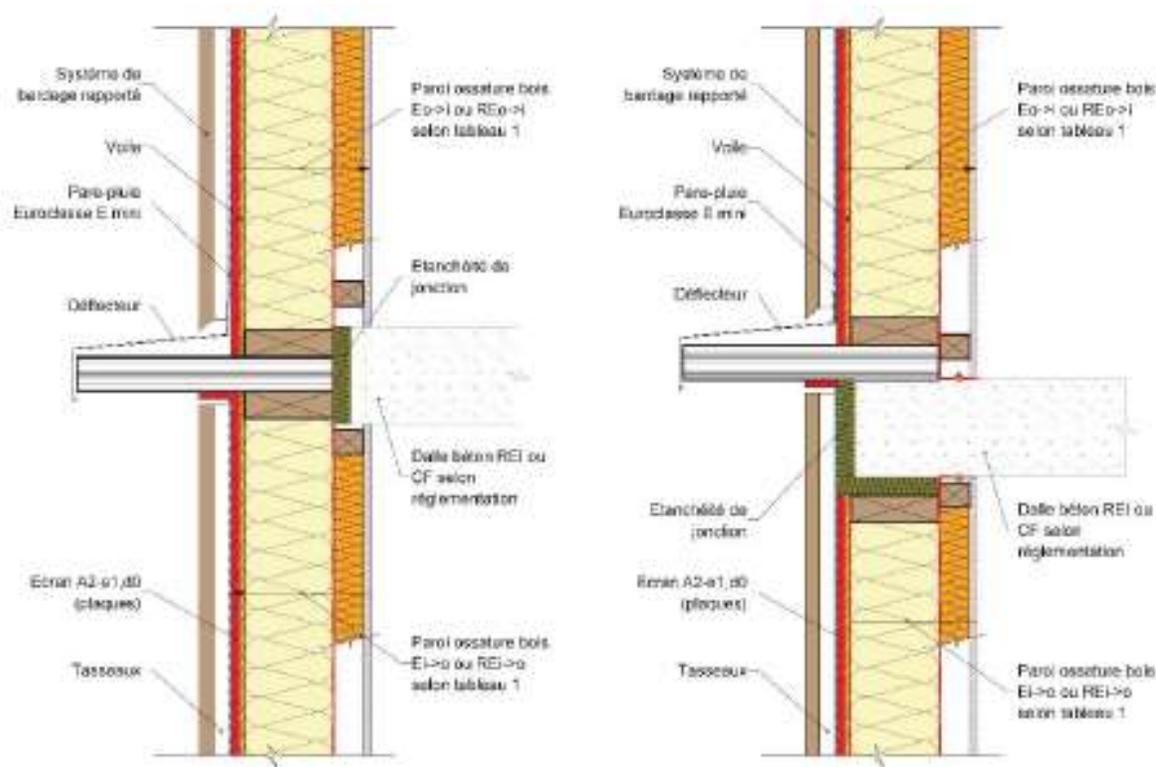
Exemple de paroi avec déflecteurs renforcés d'une Façade ossature bois sur plancher en béton.
